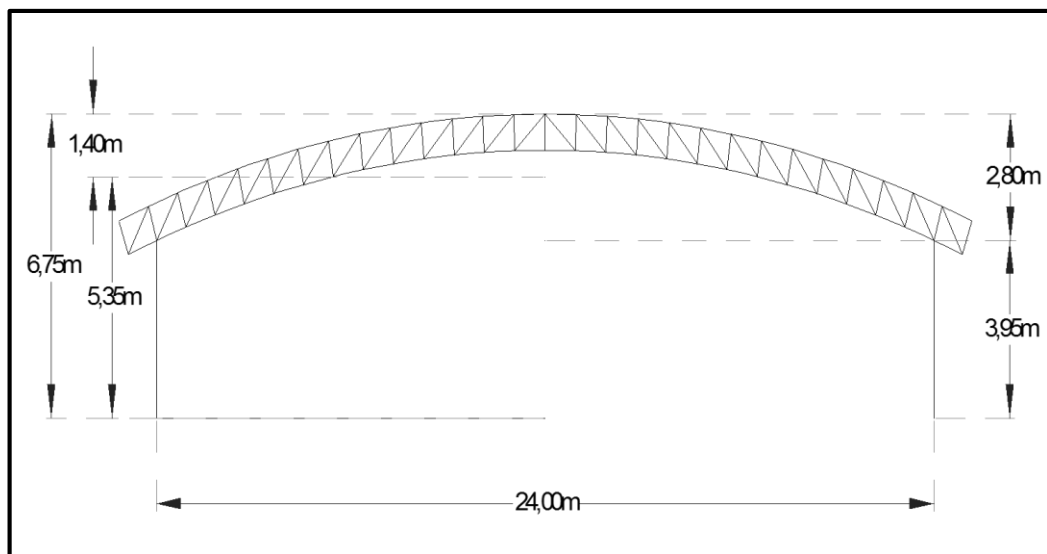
Dimensiones de la armadura propuesta apoyada sobre las columnas
